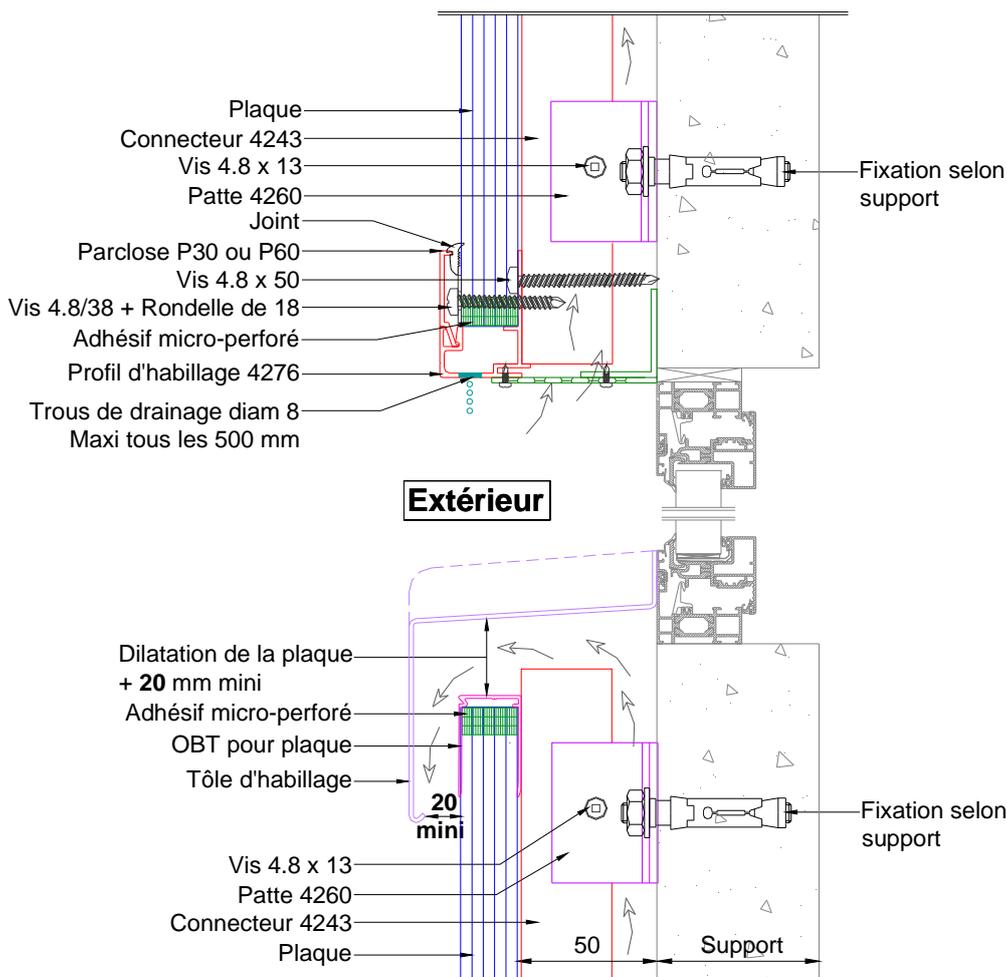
Encadrement d'une baie en tunnel – Coupe horizontale
